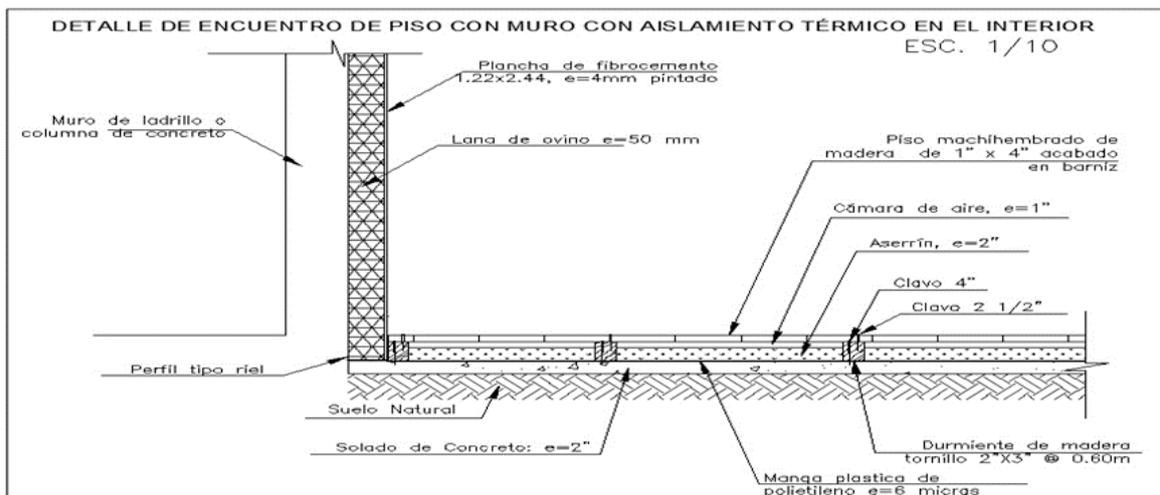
Plano de detalle de encuentro de piso con muro con aislamiento térmico en el interior
